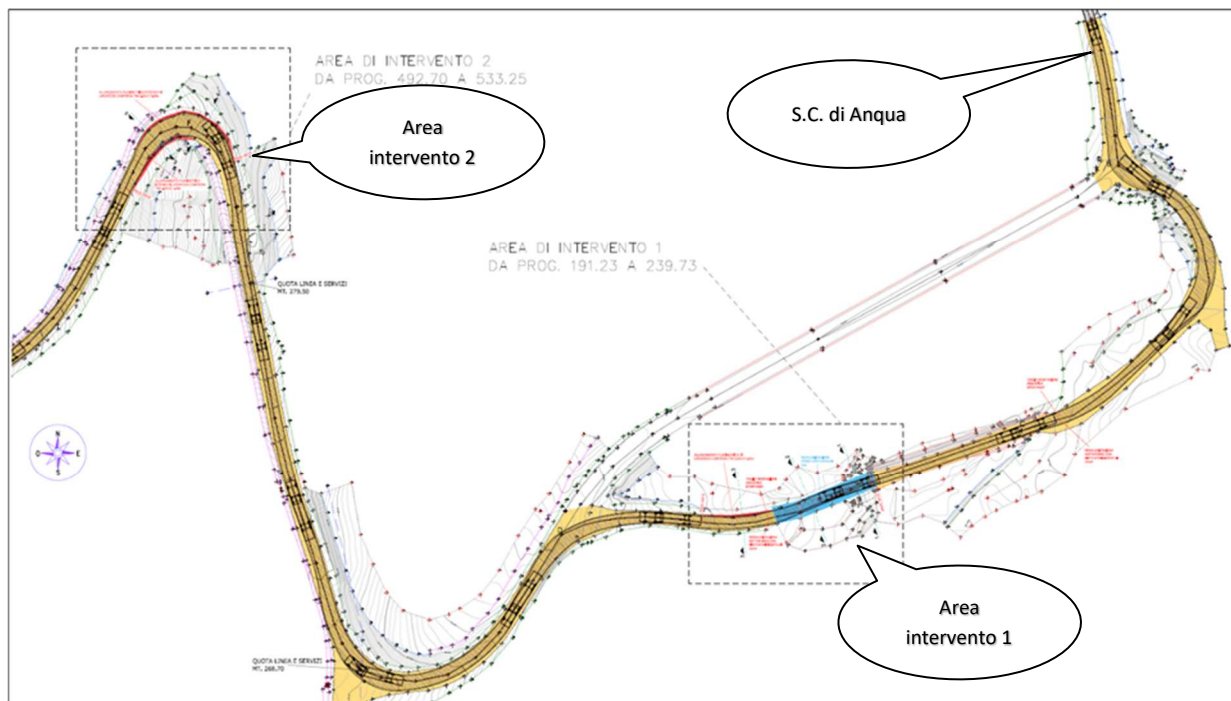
Stralcio planimetrico con indicazioni dei punti di adeguamento della viabilità.
